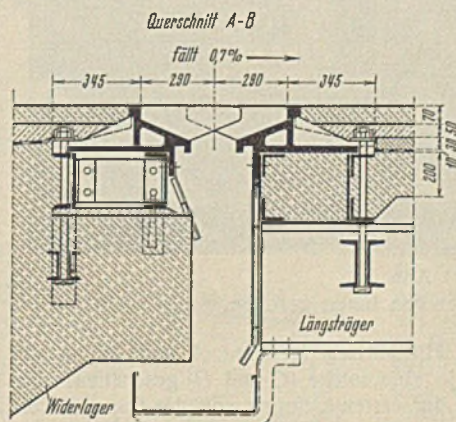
b. Fingerkonstruktion für die Bewegungsfuge.
